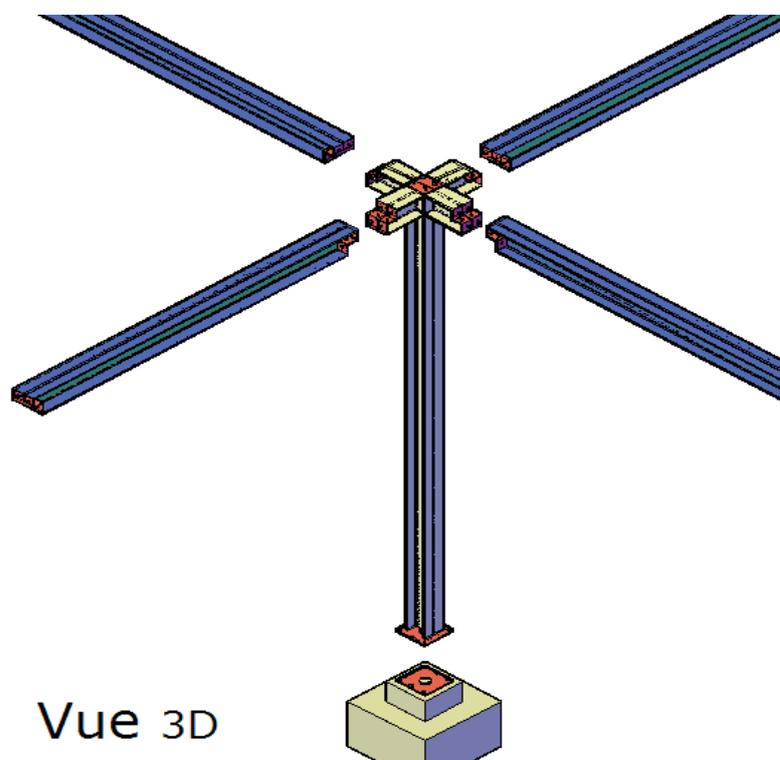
Detail assemblage poteau central avec poutre et semelle
